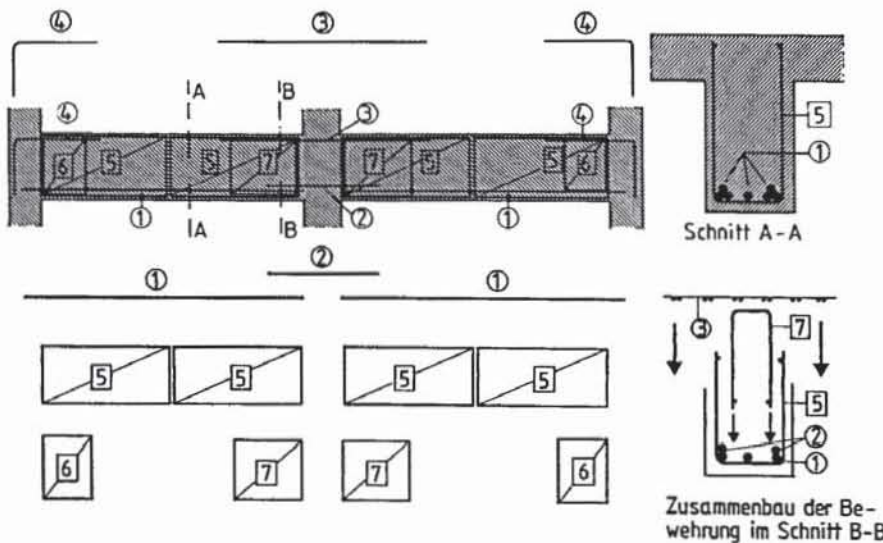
Bewehrung eines Durchlaufträgers: Schemabewehrungsplan für ein rationalisiertes System. 1, 2 Feldbewehrung; 3 Stützbewehrung; 5 Bügelkorb; 6, 7 Schubzulagen
